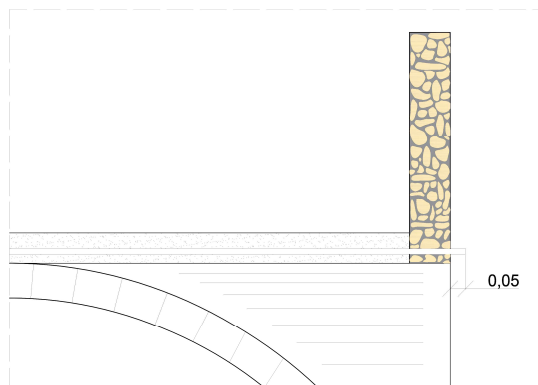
Detalle separación desagüe. Fuente: Elaboración propia.
